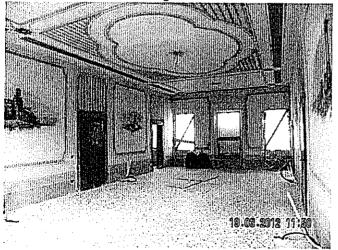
Stanza 1.5 (sala)- Vista interna parete .lato strada.
